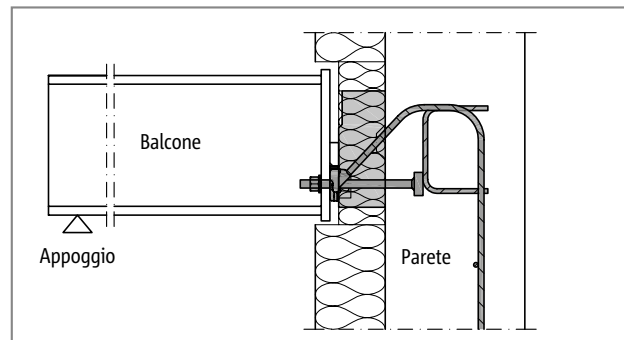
Schöck Isokorb® T tipo SQP-WU: situazione speciale; necessaria per raccordare una parete in calcestruzzo armato
